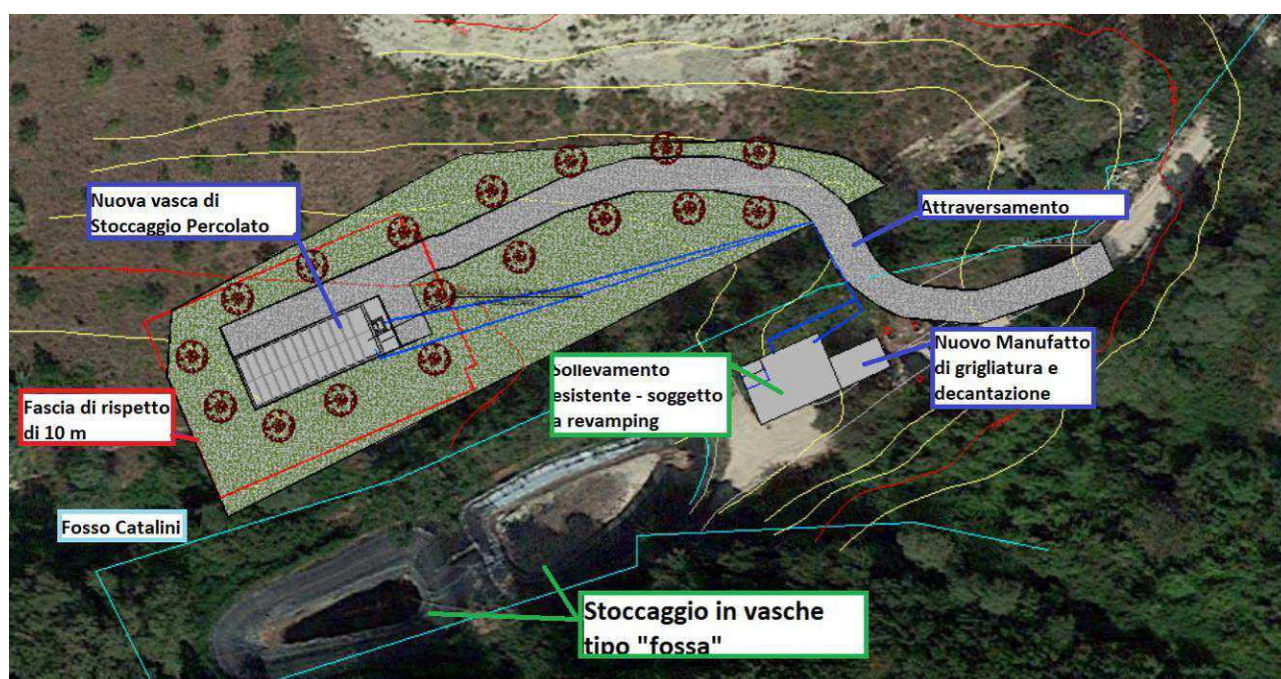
Planimetria di dettaglio zona intervento 1 con individuazione opere
